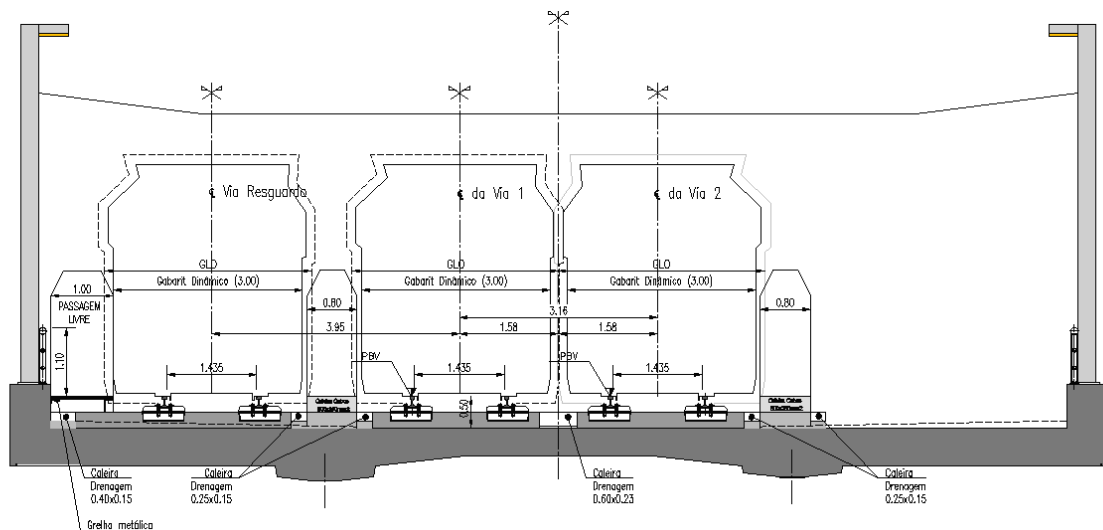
Secção transversal funcional da Via de Resguardo em Trincheira
